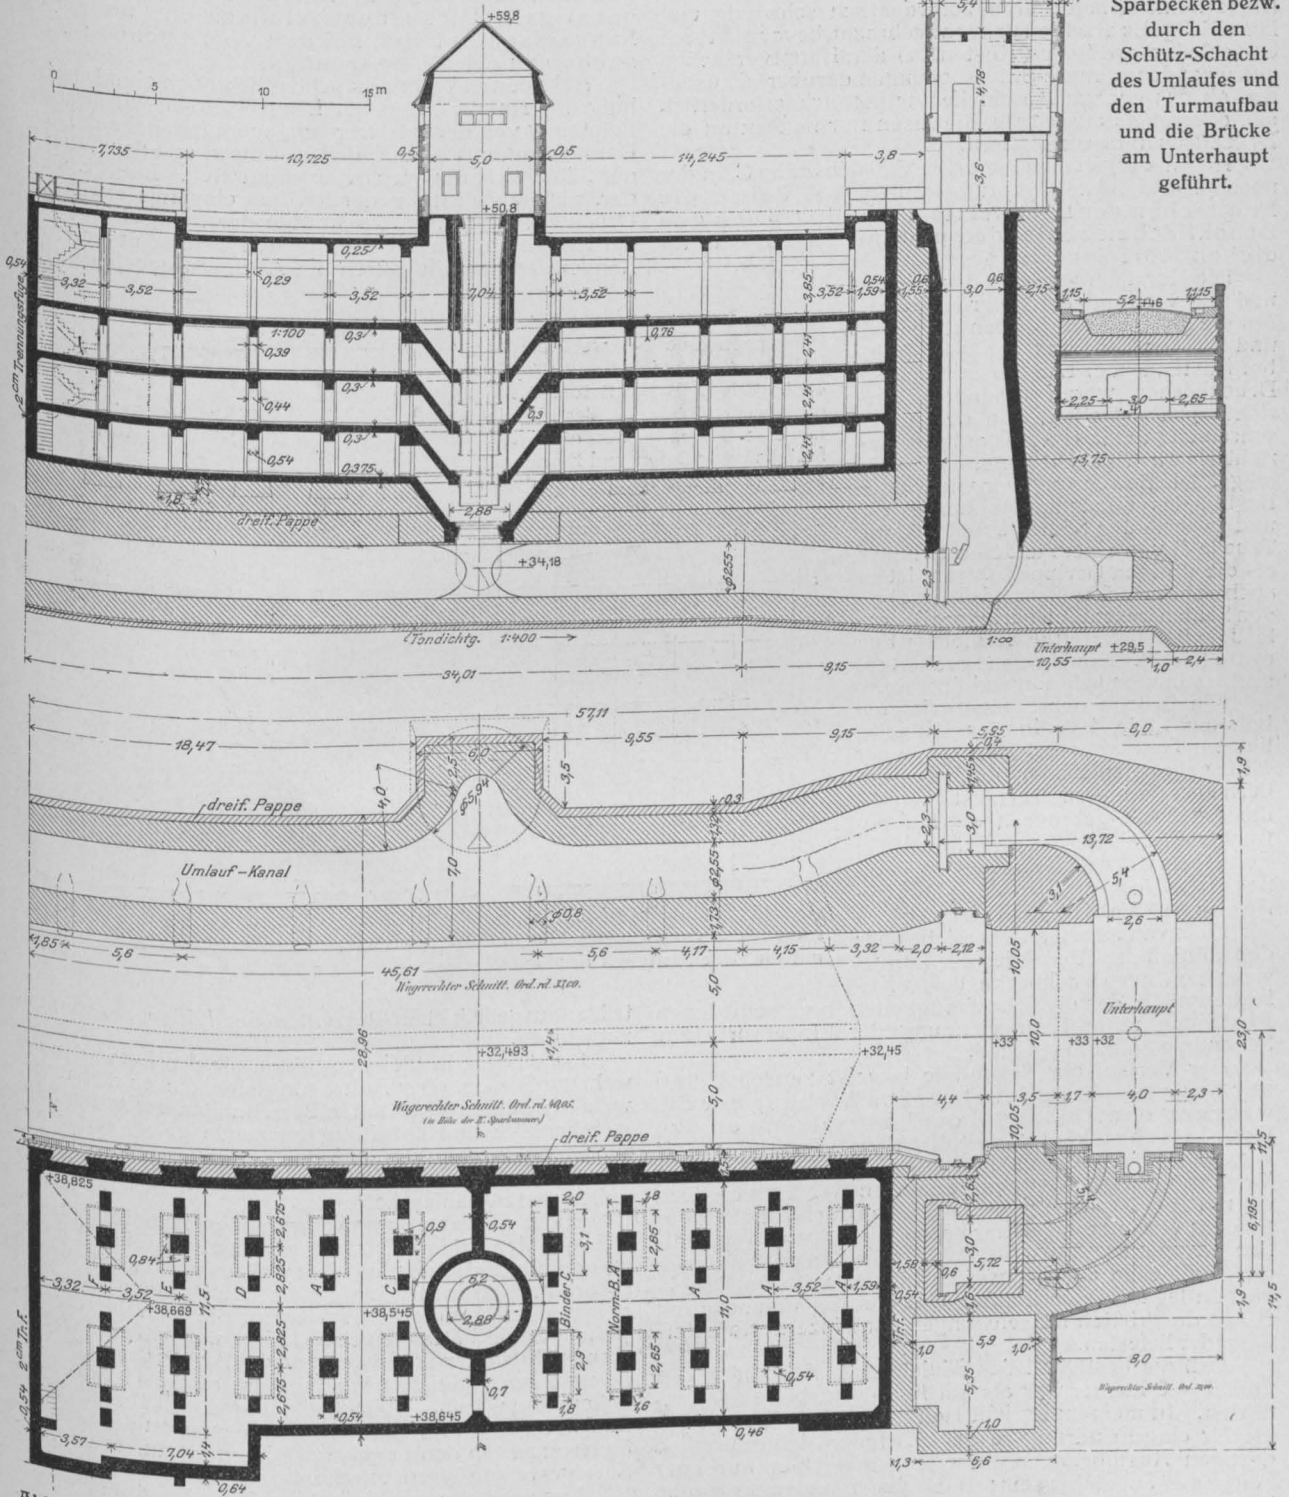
Halber Schleusengrundriß am Unterhaupt. (Horizontalschnitt durch den Umlaufkanal bzw. durch die Sparkammer.)
